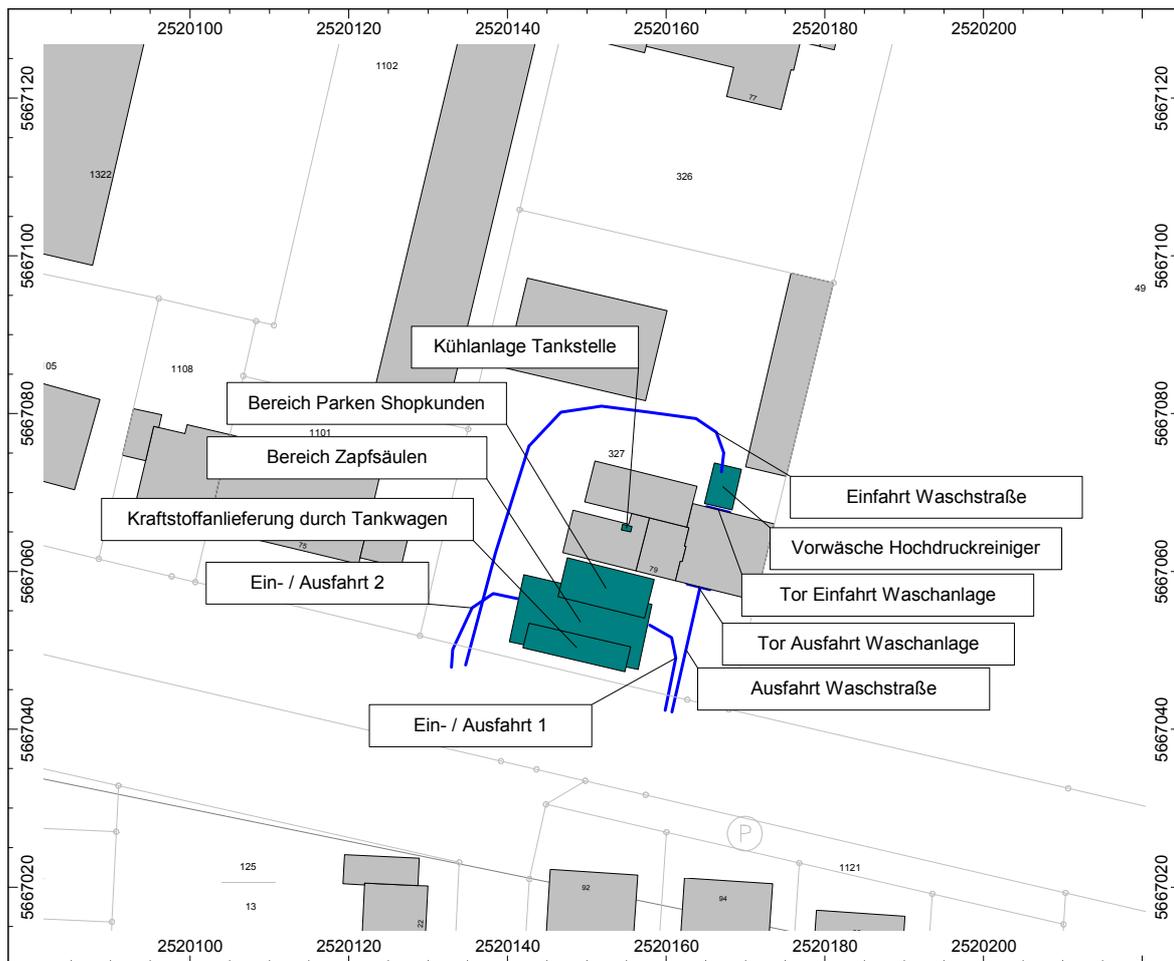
Lageplan der Tankstelle mit Kennzeichnung der Quellen
